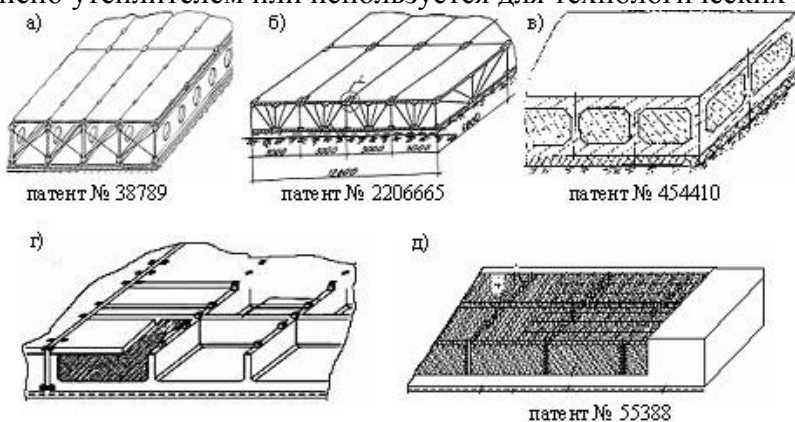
ПФП (варианты): а и б сталежелезобетонные платформы с вентилируемым подпольем для вечномёрзлых грунтов; в) – монолитная ПФП со встроенной теплоизоляцией; г, д) – сборный и сборно-монолитный варианты с теплоизоляцией
